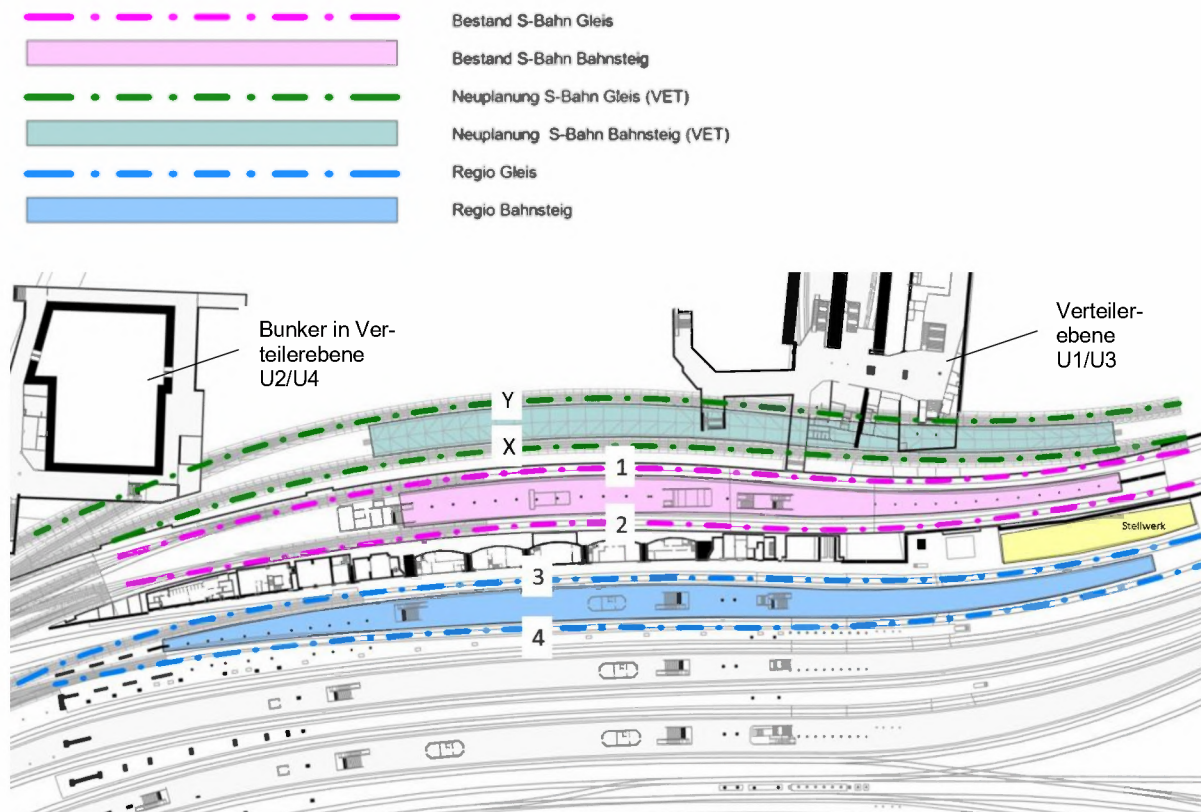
Hbf, VET-Station Grundriss gemäß Konzeptstudie (Variantenuntersuchung) [U8]
